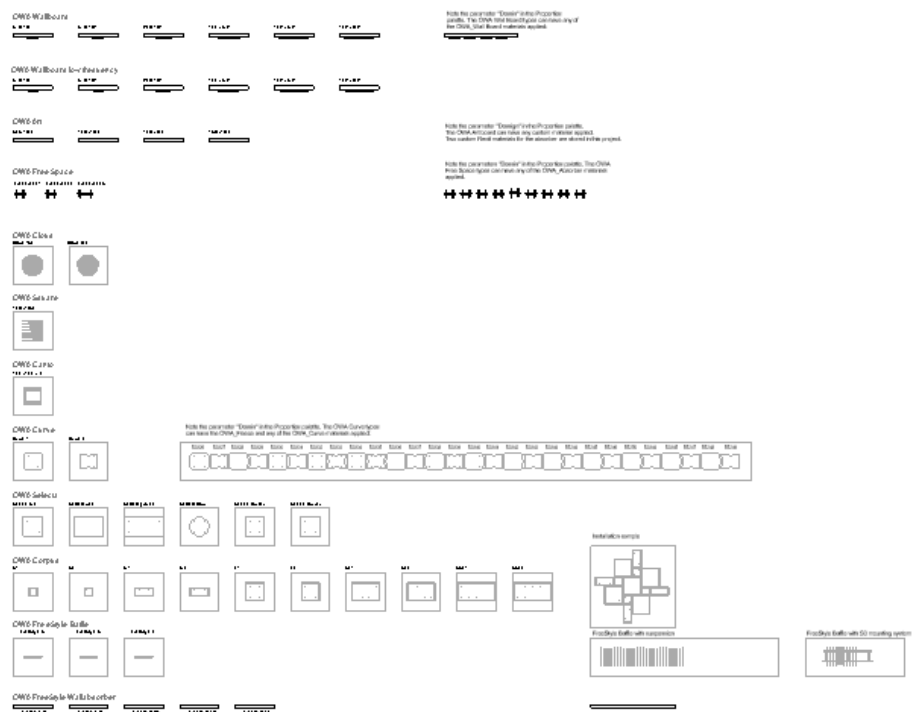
Grundriß Darstellung im Projekt Revit Specialty Equipment Library.rvt.
